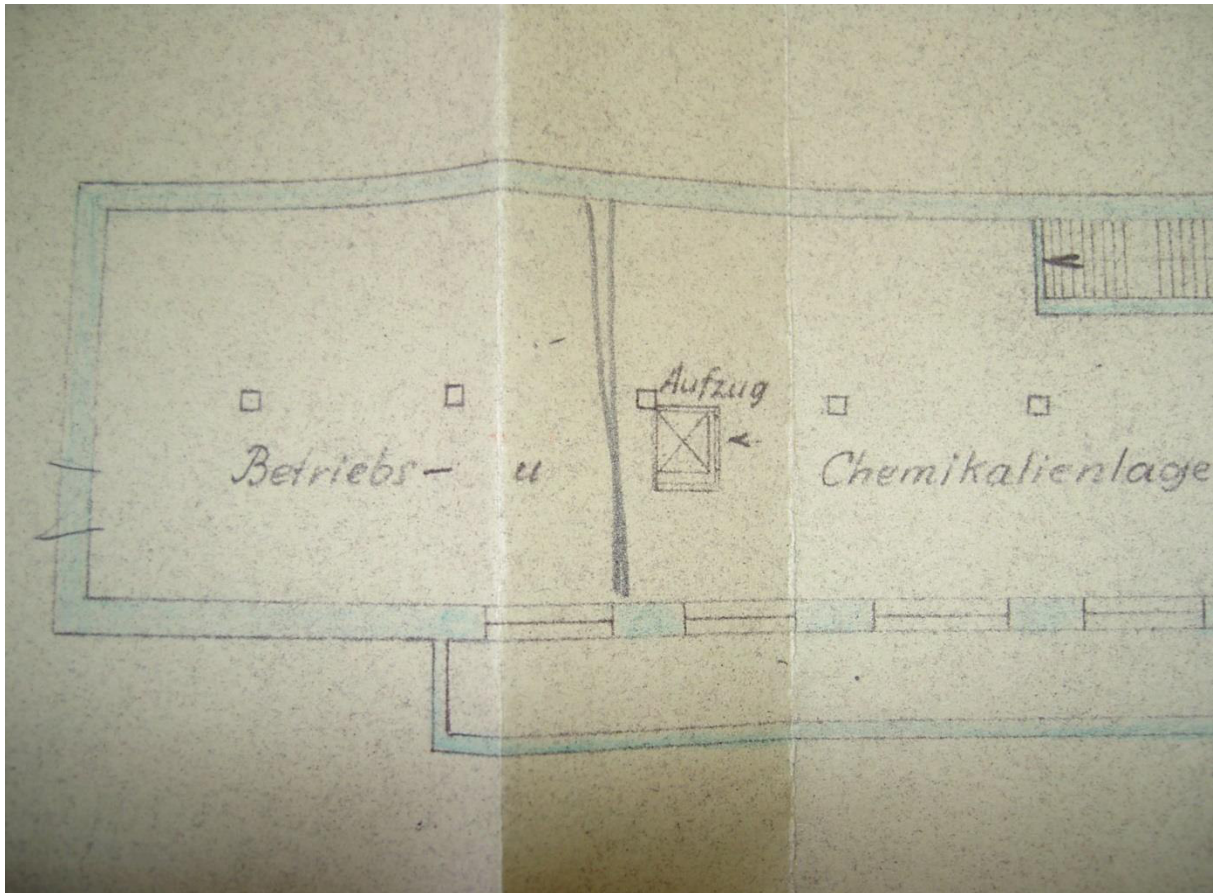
Schriftätzerei, 2. Entwurf, Grundriss
